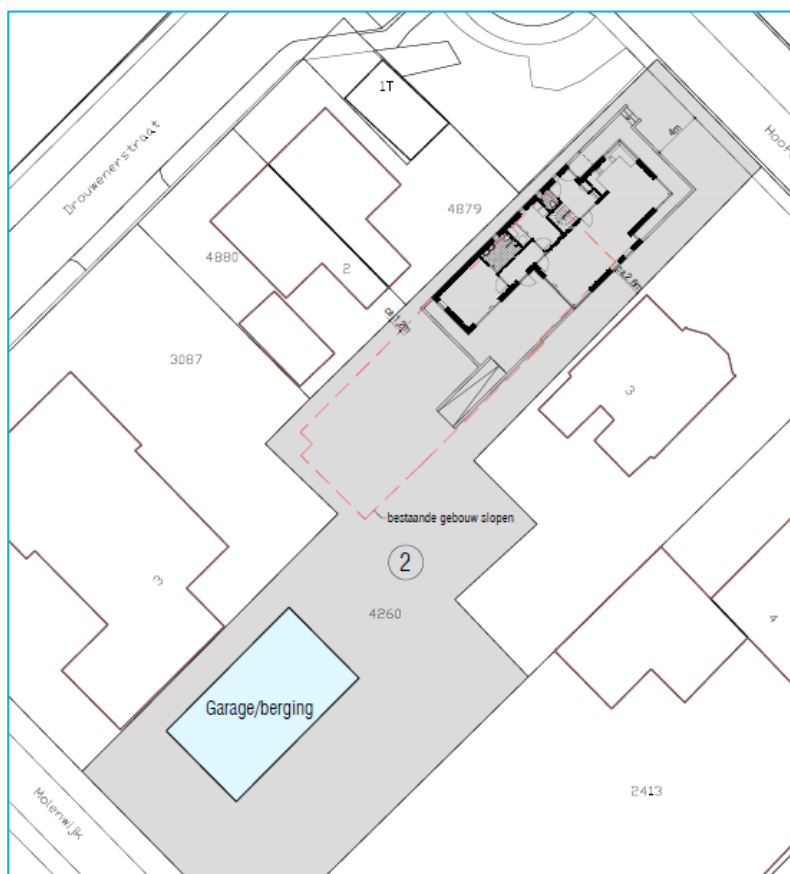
Weergave van het plangebied met daarop het bestaande kerkgebouw
